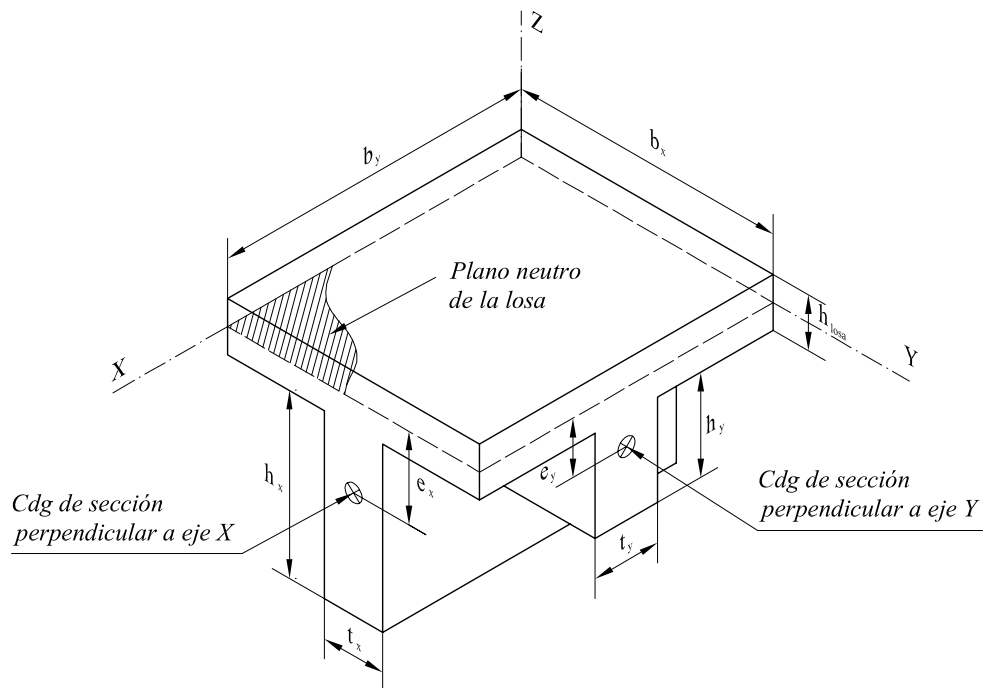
Elemento de tablero de vigas y losa. Nomenclatura empleada
